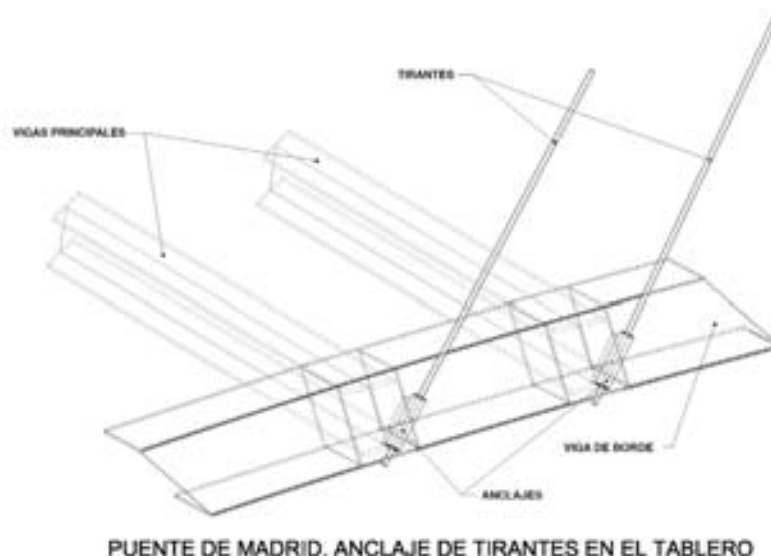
Vigas principales, viga de borde y anclaje de los tirantes en el tablero.
